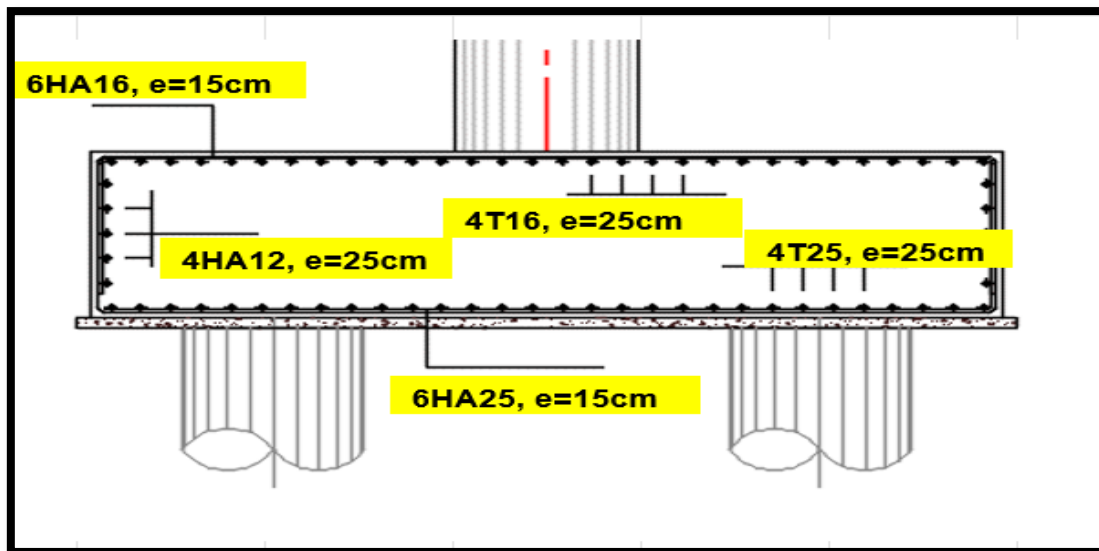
FERRAILLAGE DE LA SEMELLE
